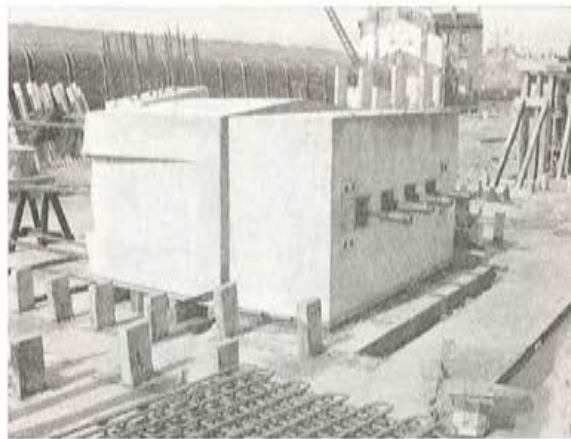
Articulación prefabricada, de cabeza de soporte, en su área de construcción. Obsérvense los cuatro cables de 75 Mp., para el pretensado antes de su elevación.
